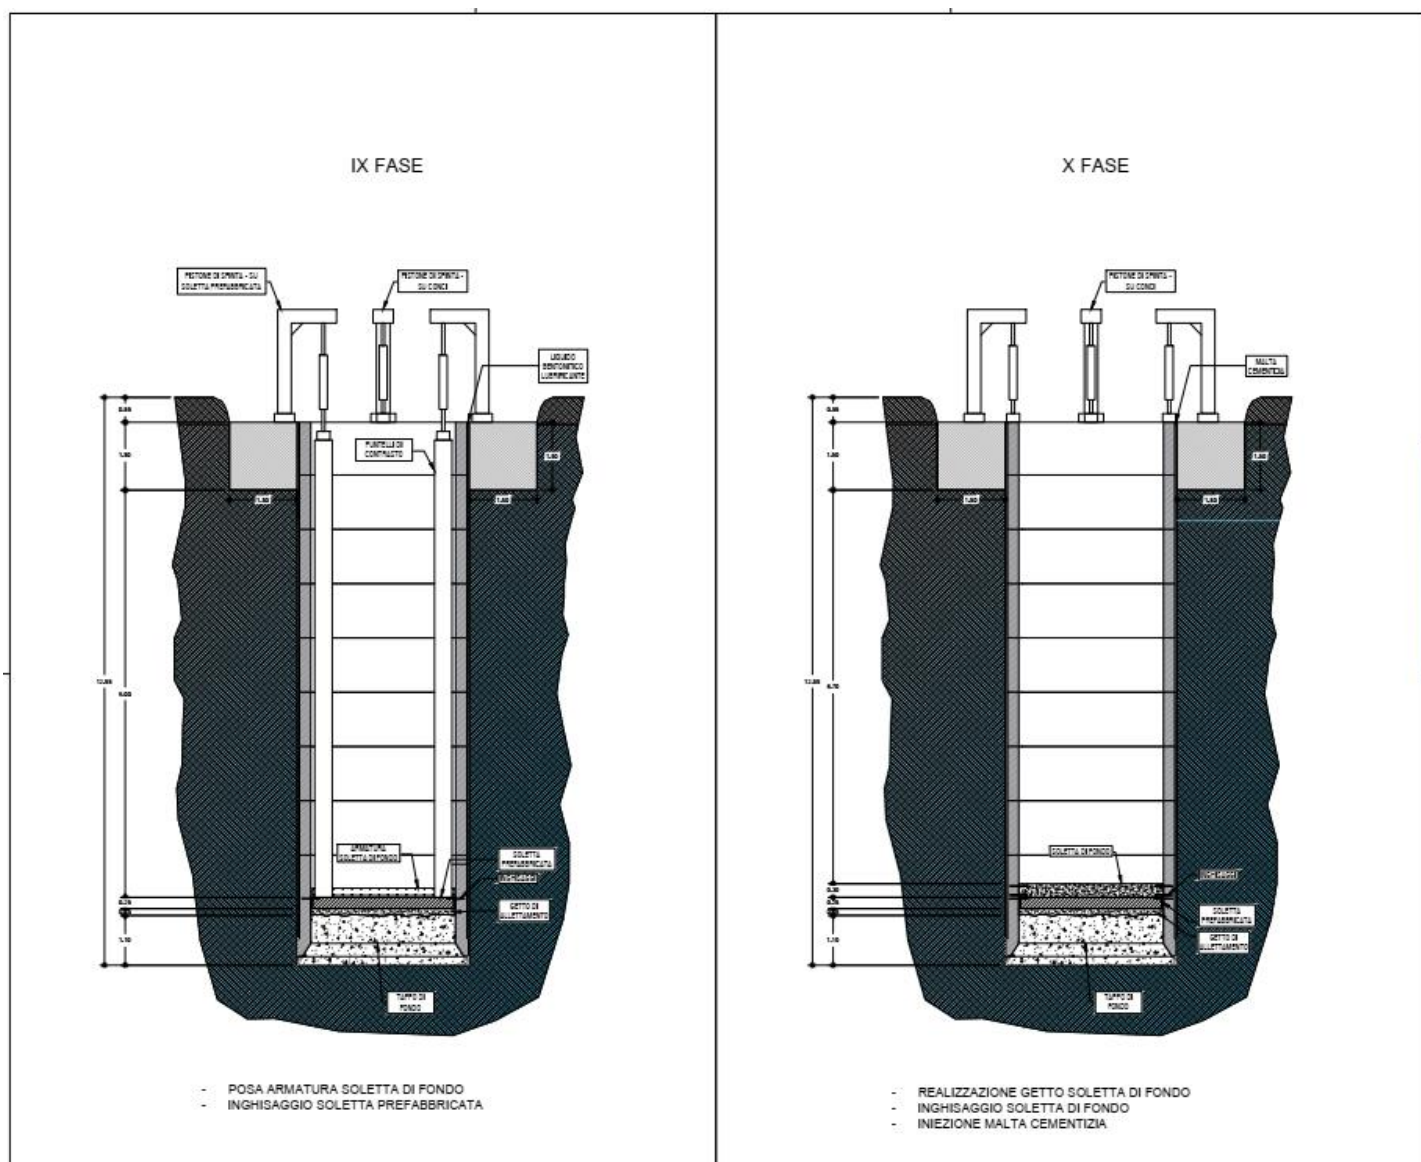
B : Schema tecnico realizzazione pozzo autoaffondante
